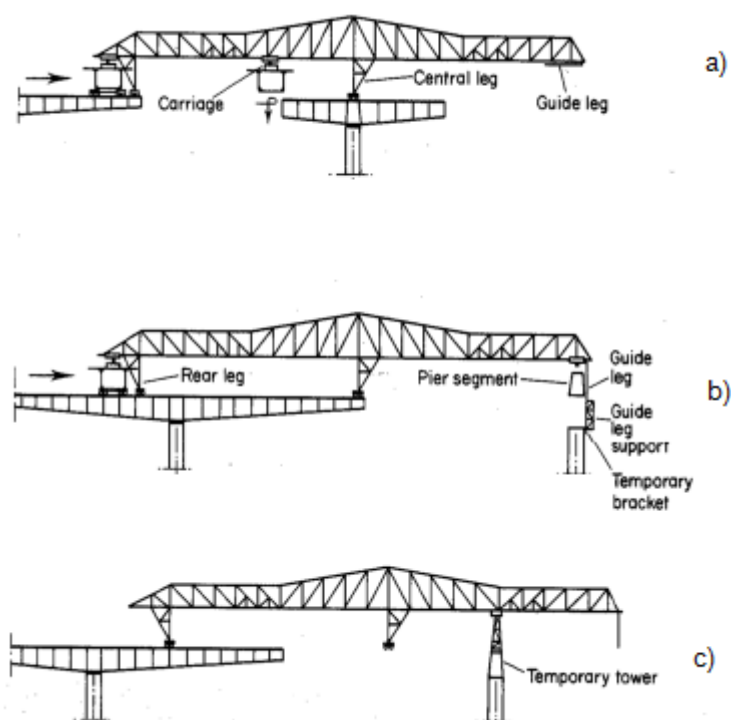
Fases de construção com viga de lançamento (Mathivat 1979)
